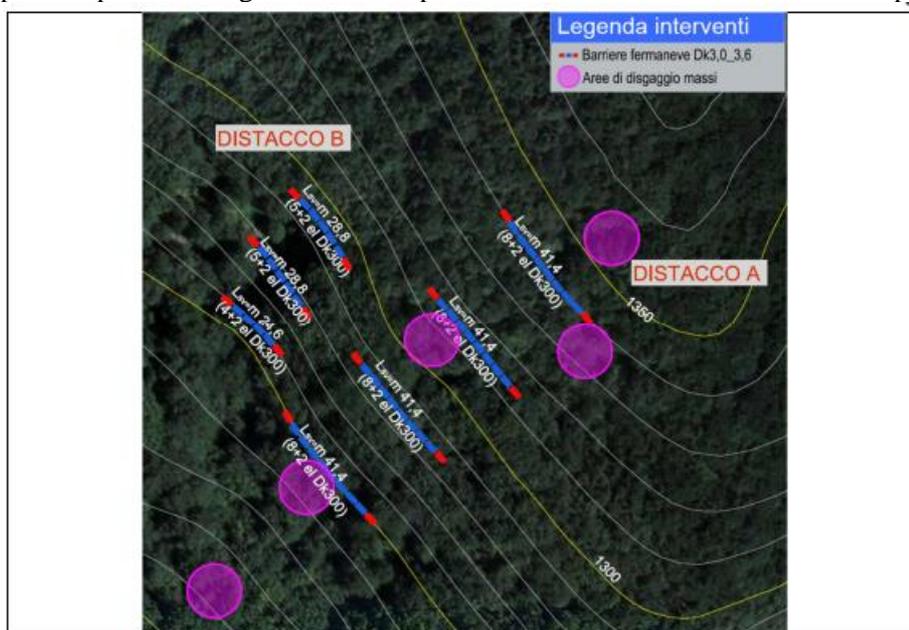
Planimetria barriere fermaneve in progetto (Elaborato B12)
